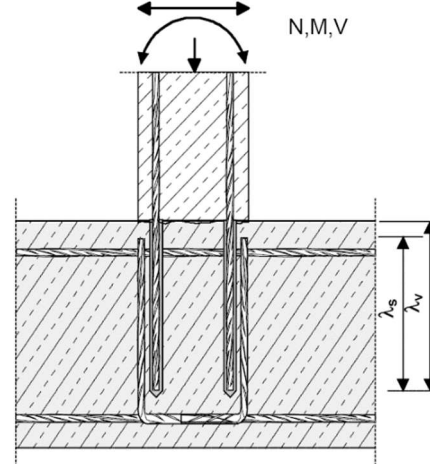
Ancrage direct d'armatures en extrémité de dalles ou poutres, simplement appuyé
